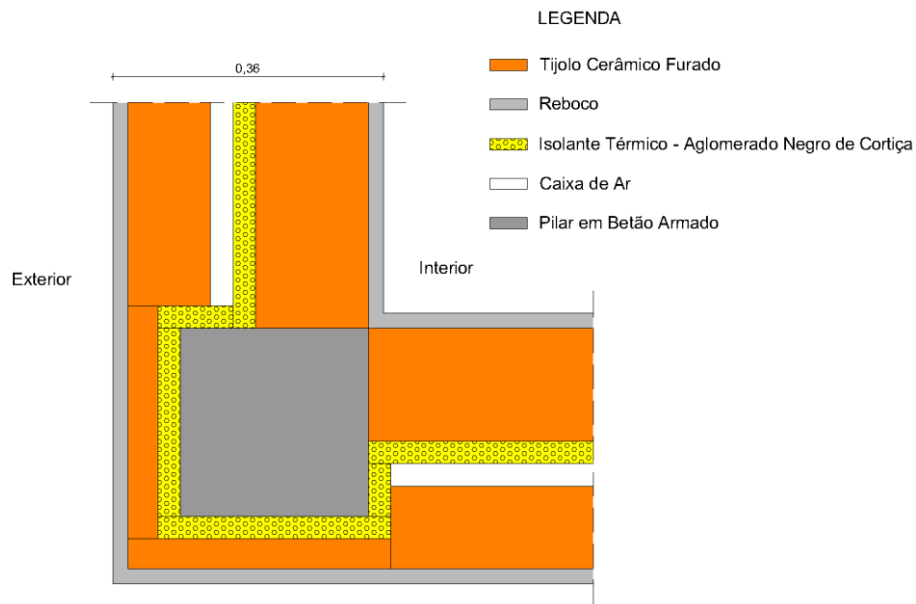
Ligação entre duas paredes verticais, adaptado de [10]
